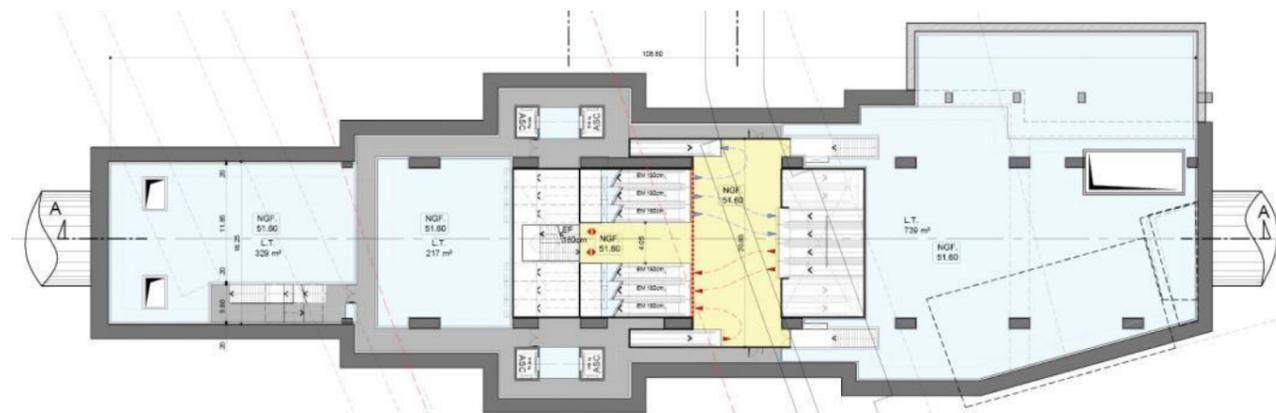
Gare d'Arcueil Cachan - Plan niveau N-1
